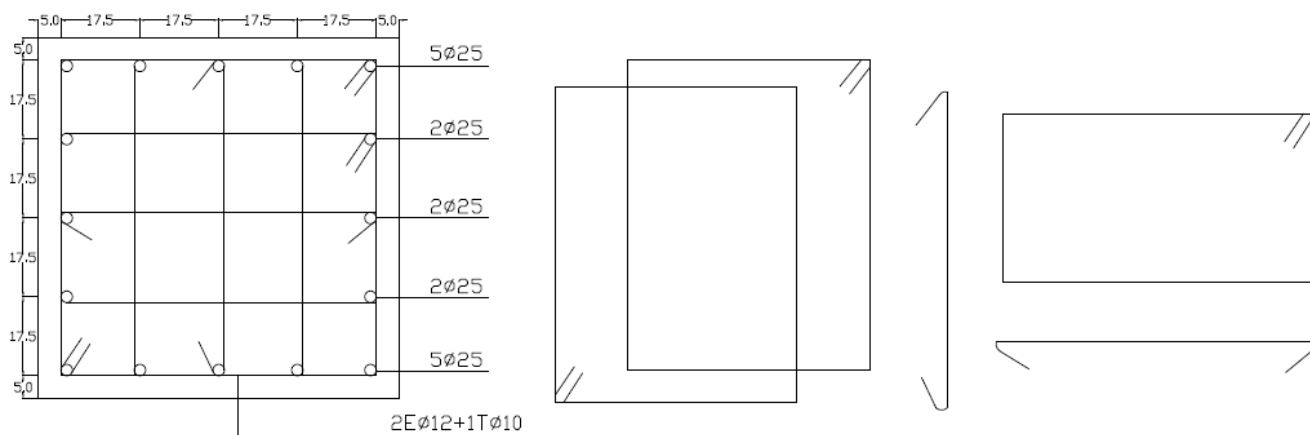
Sección transversal de las columnas del caso de estudio 1
